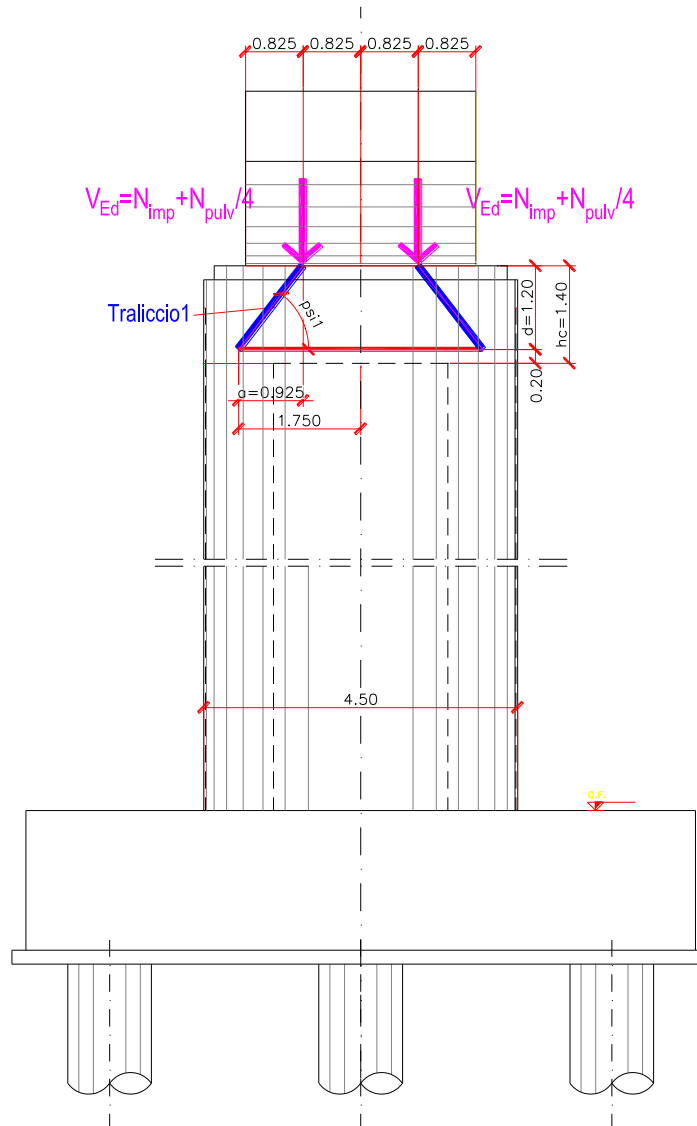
Schema statico per verifica tappo testa pila – Pila-Spalla
